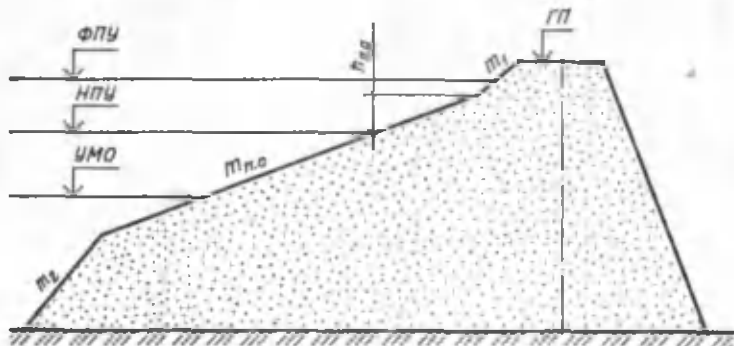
Схема к расчету неукрепленного верхового откоса
